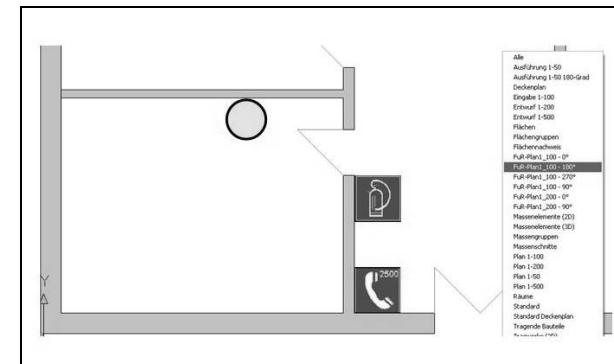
Grundriss mit alternativen Aufhängepunkt um 180° gedreht
